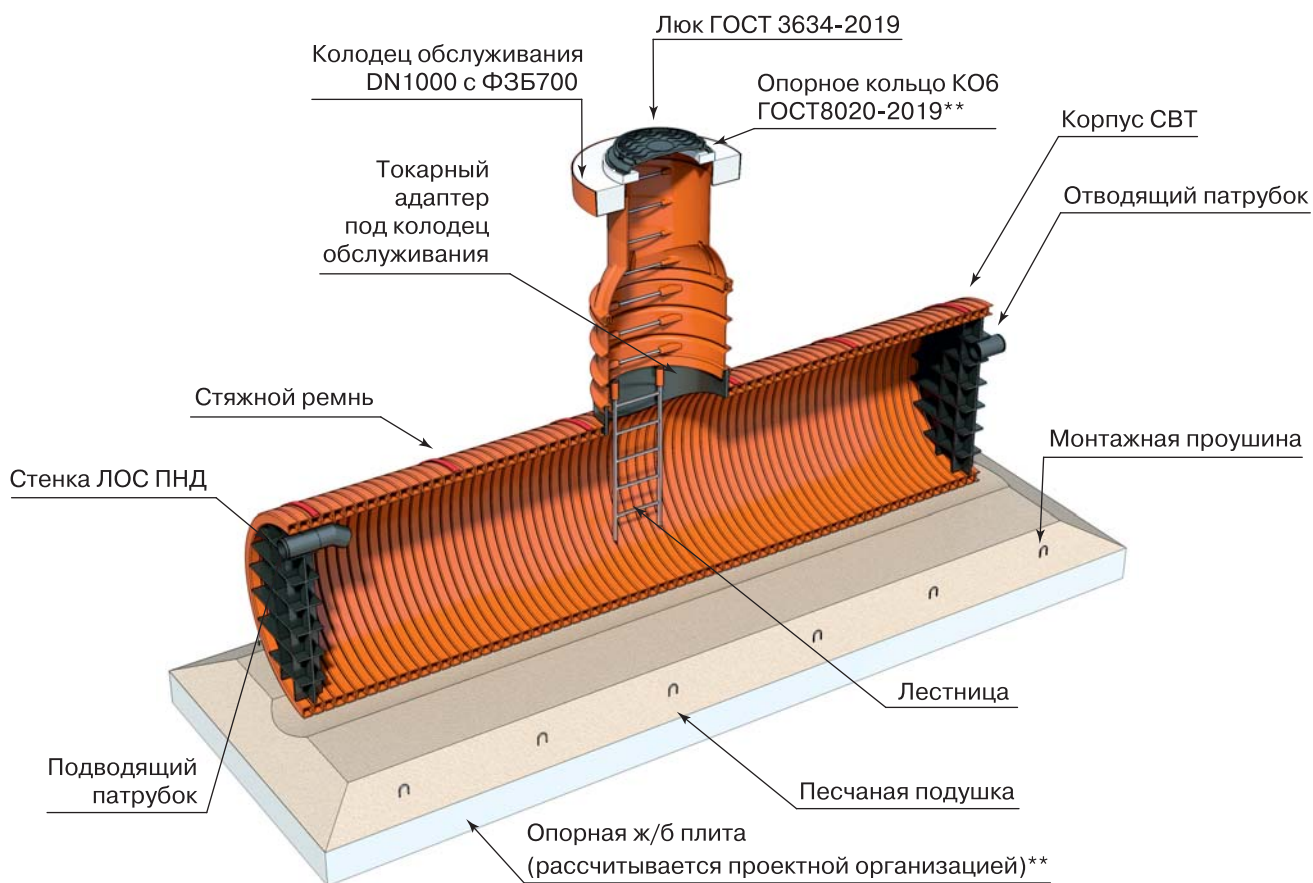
Типовой чертеж резервуара ИКАПЛАСТ.
